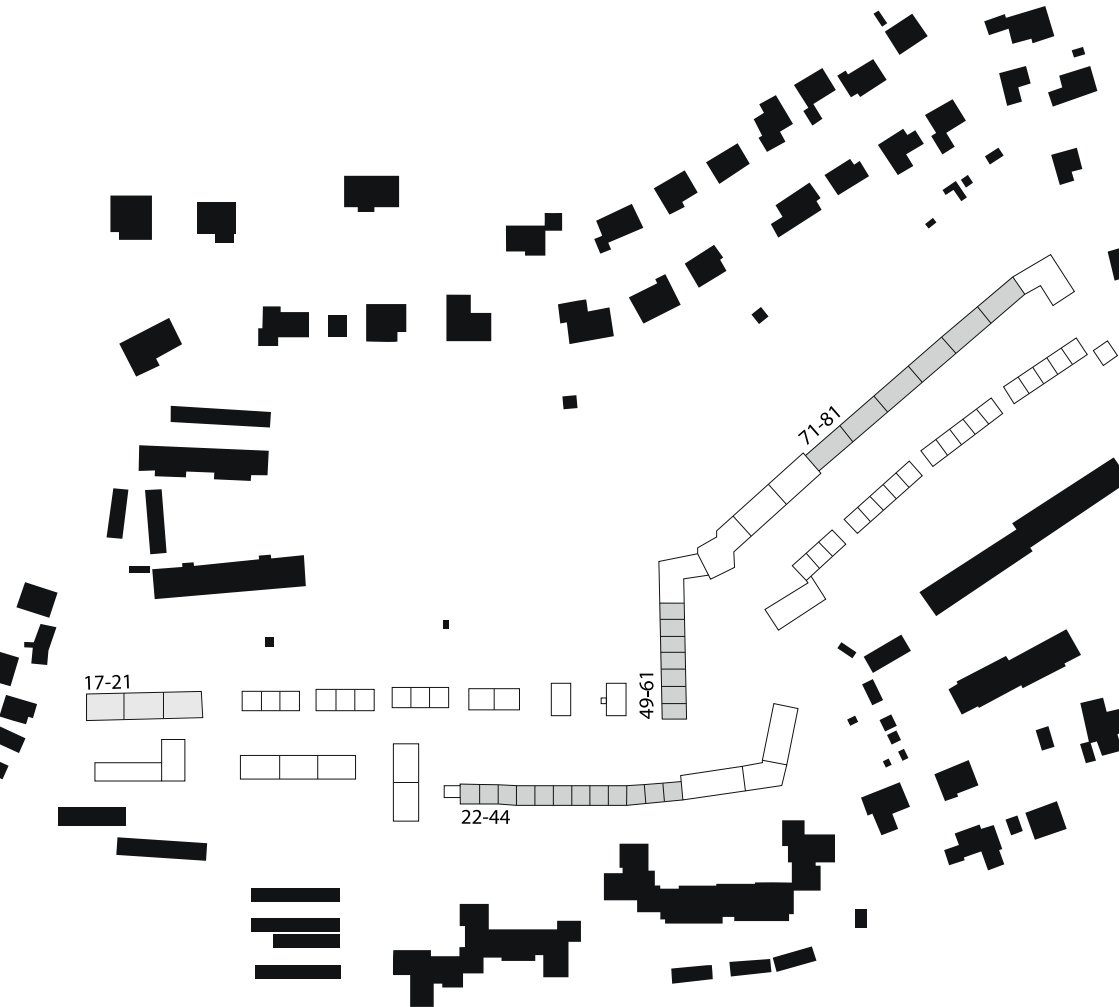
Bilweis, Lageplan mit Verortung der vorhandenen Grundrisse
